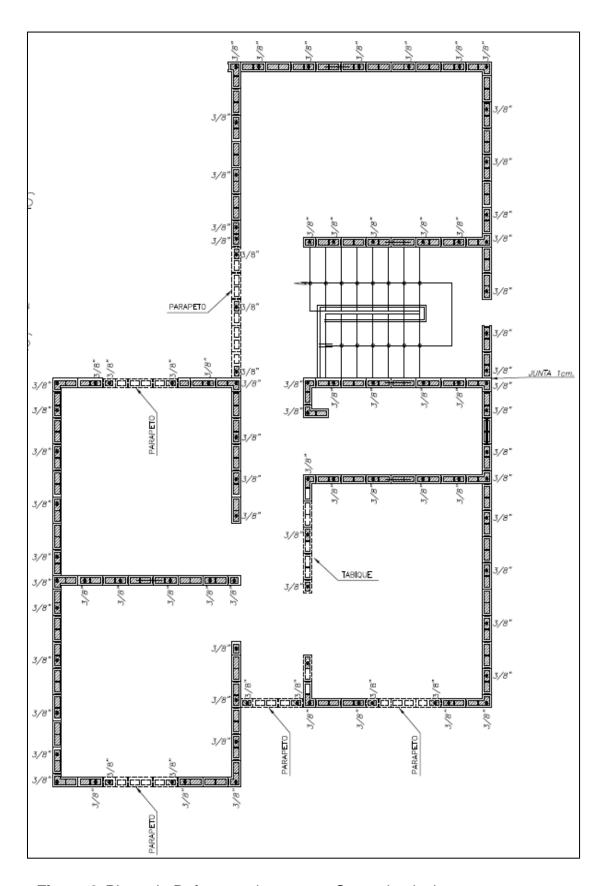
Plano de Refuerzos de muros – Segundo nivel.
